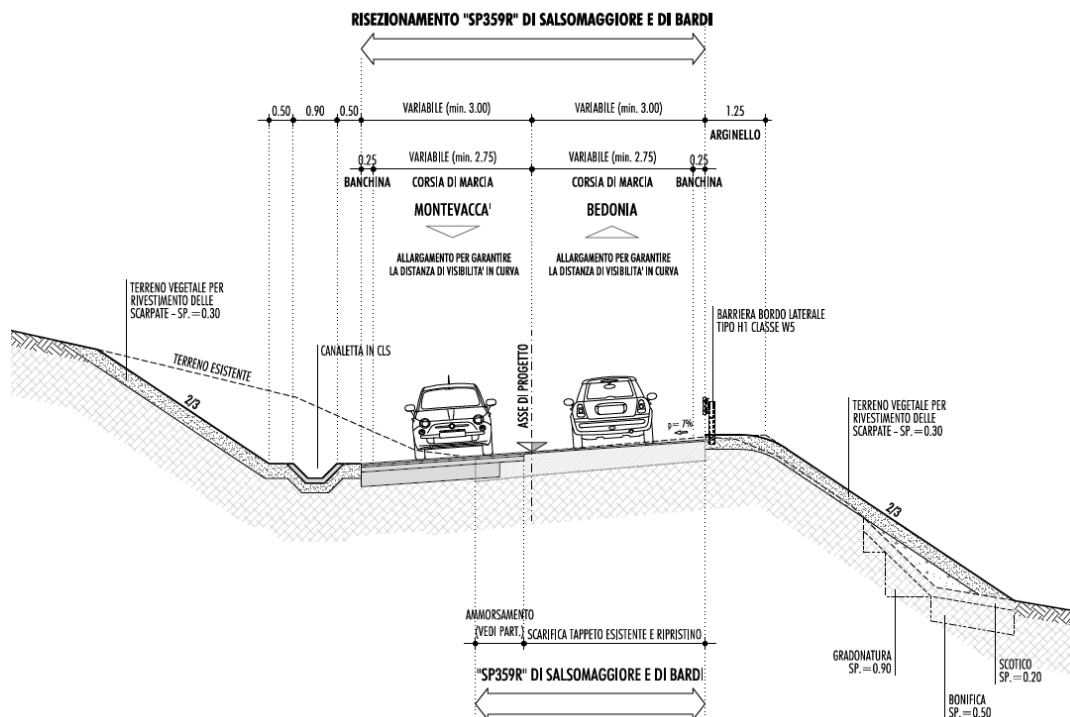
SEZIONE TIPO TRATTO 1 CON SCAVO LATO MONTE
